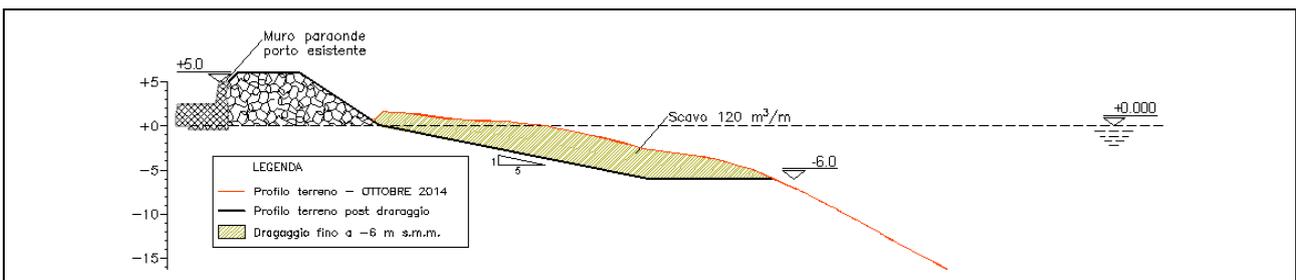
Sezione di dragaggio a ridosso della scogliera in tetrapodi (sezione Z-Z')
